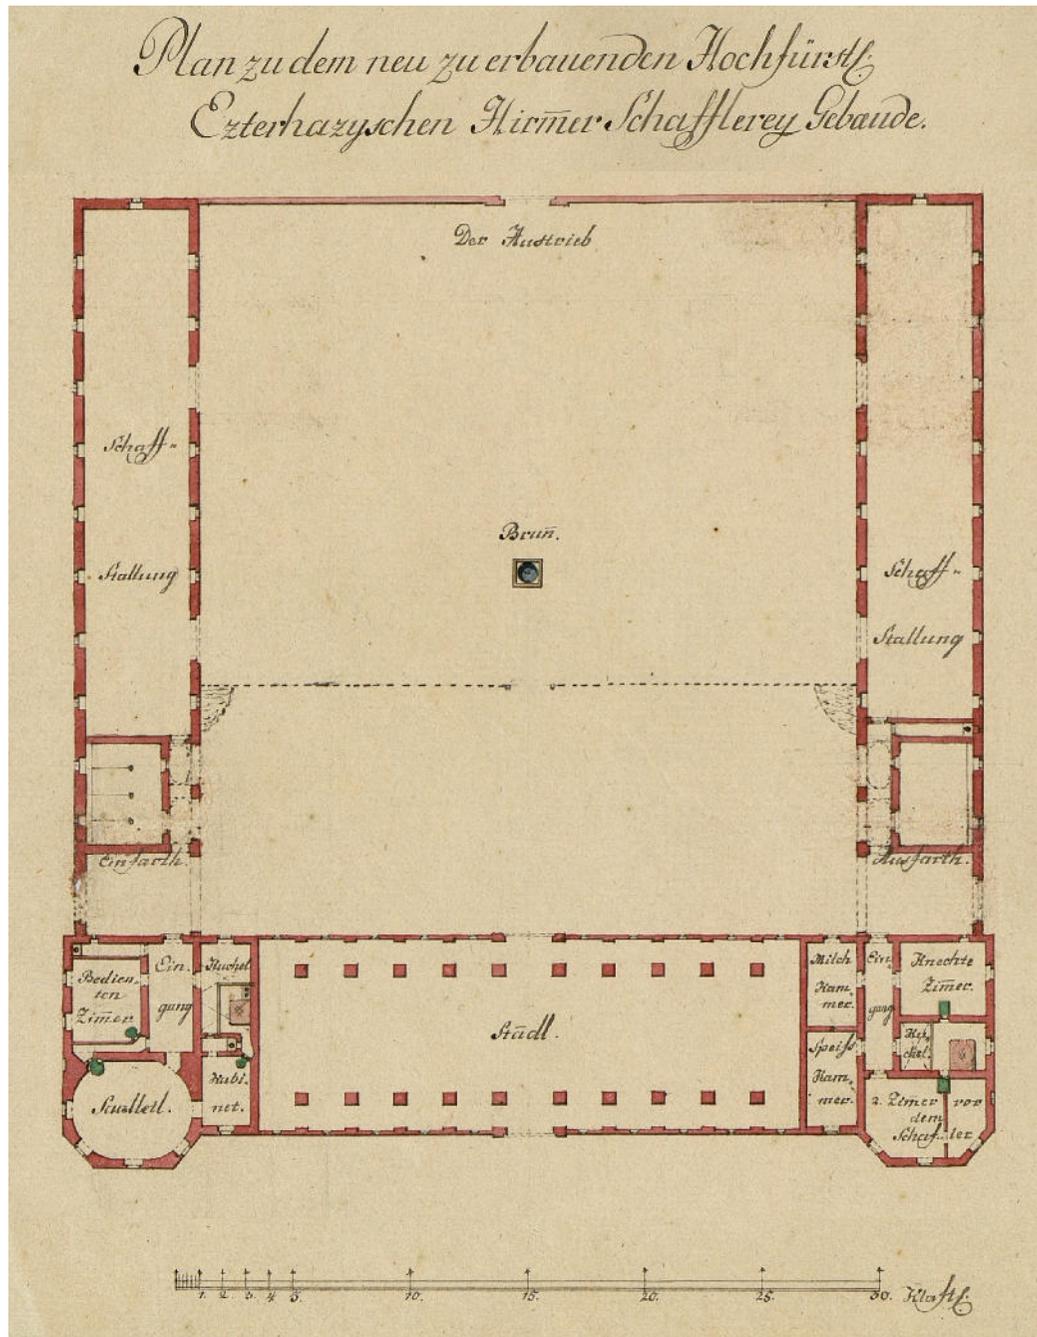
Schafhof in Hirm (Herrschaft Forchtenstein, zw. 1800-1828 der Herrschaft Pötsching zugeteilt)
